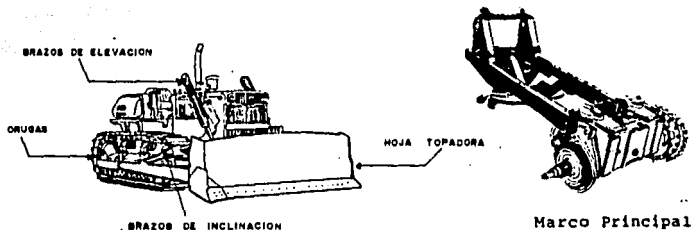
PRINCIPALES COMPONENTES DE UN TRACTOR EMPUJADOR
